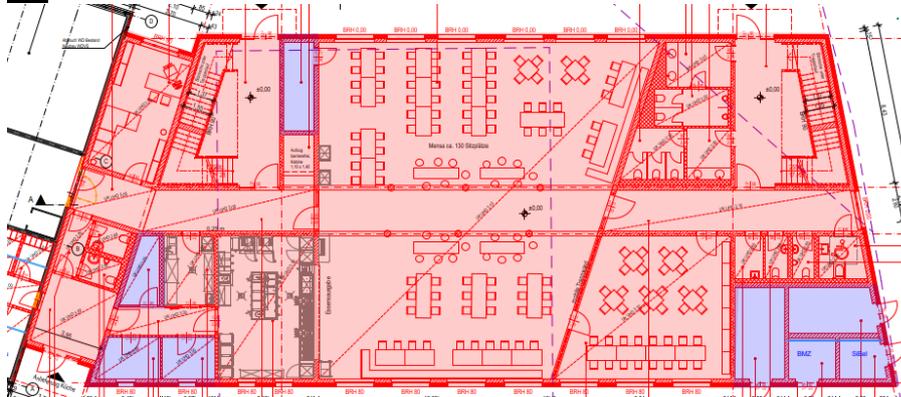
Zonierung, Darstellung im Grundriss
